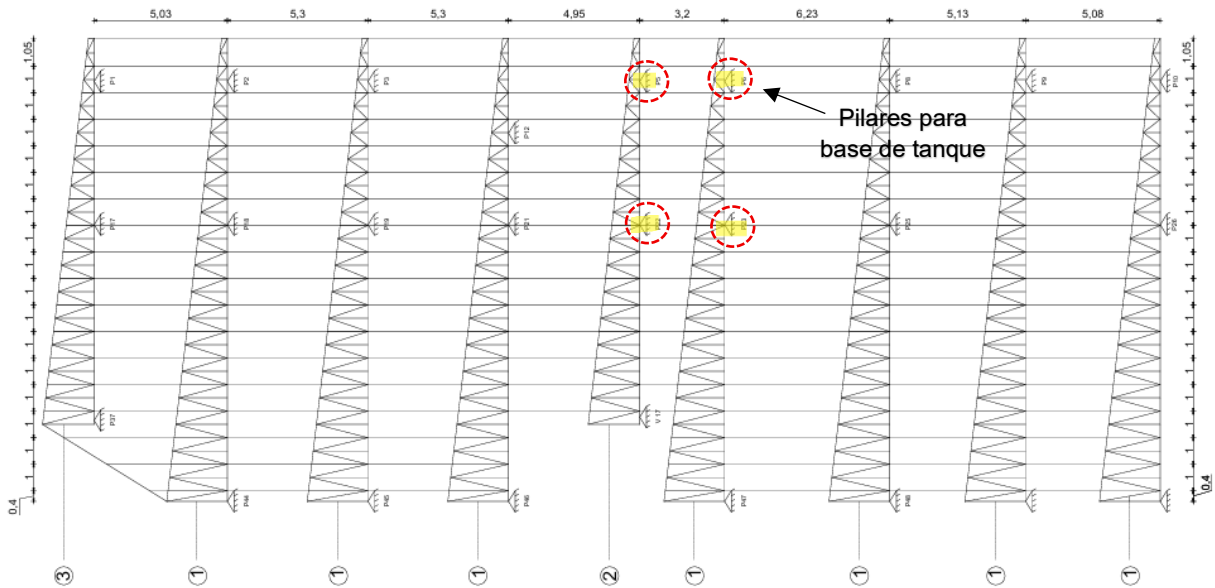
Plano de estructura de techo – ubicación de cabriadas.
